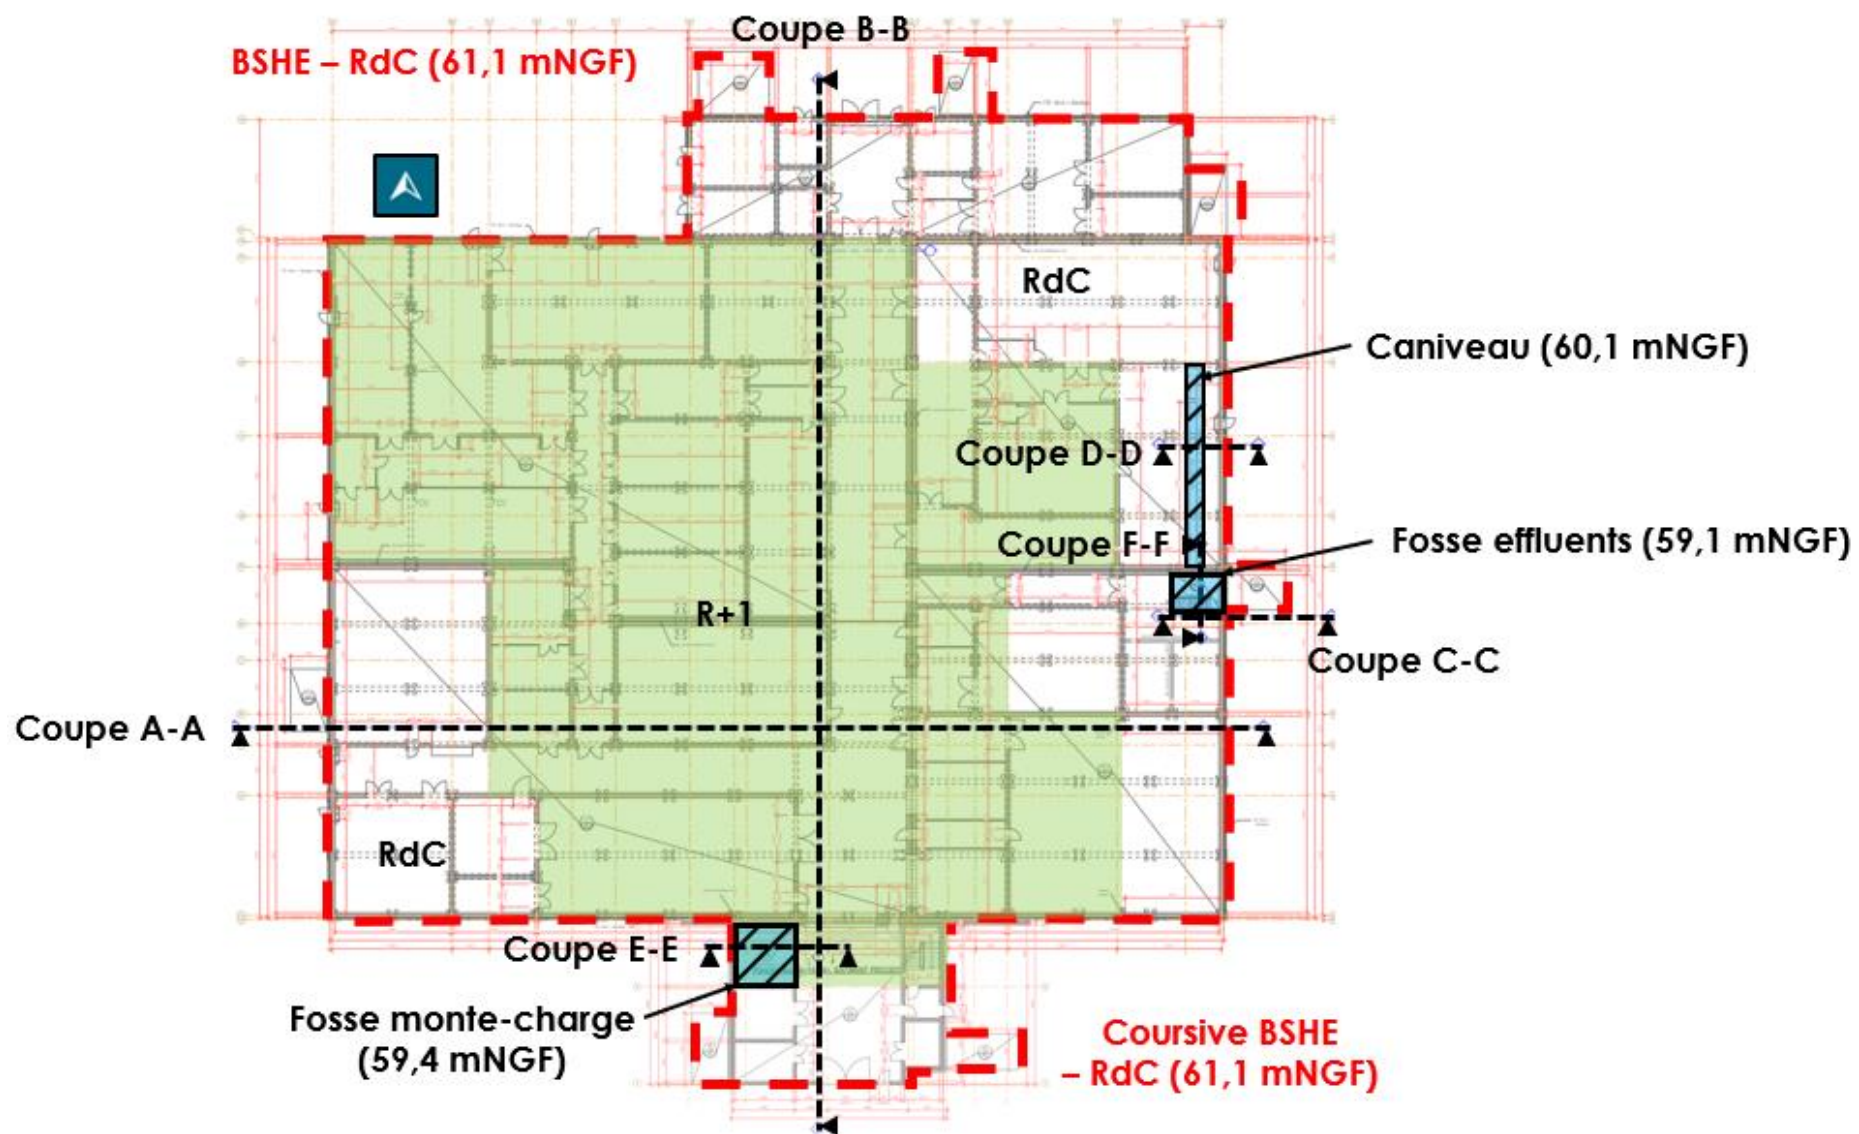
Plan du RdC du BSHE – CEA – Sans échelle
